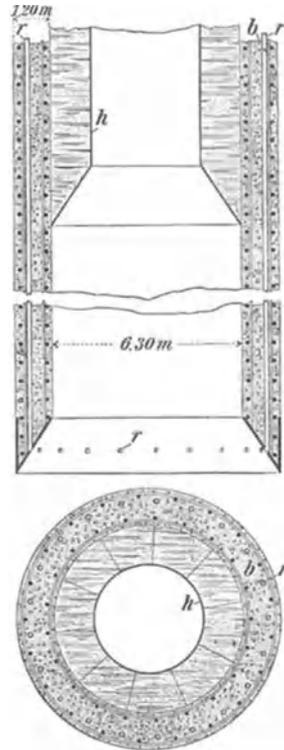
Senkschacht aus eisenbewehrtem Beton.
